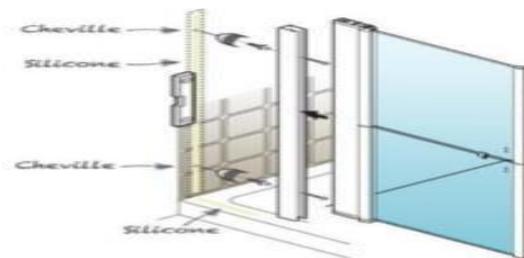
Schéma murs rideaux avec joint en silicone¹³¹
